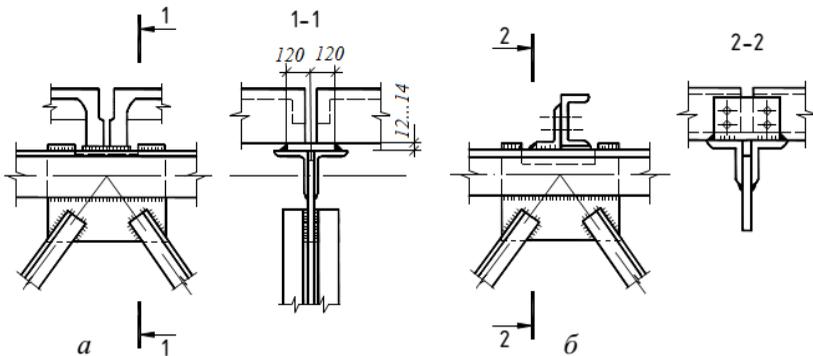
Вузли обпирання на верхній пояс ферм: *а* - ребер залізобетонних плит покриття; *б* - сталевих прогонів
